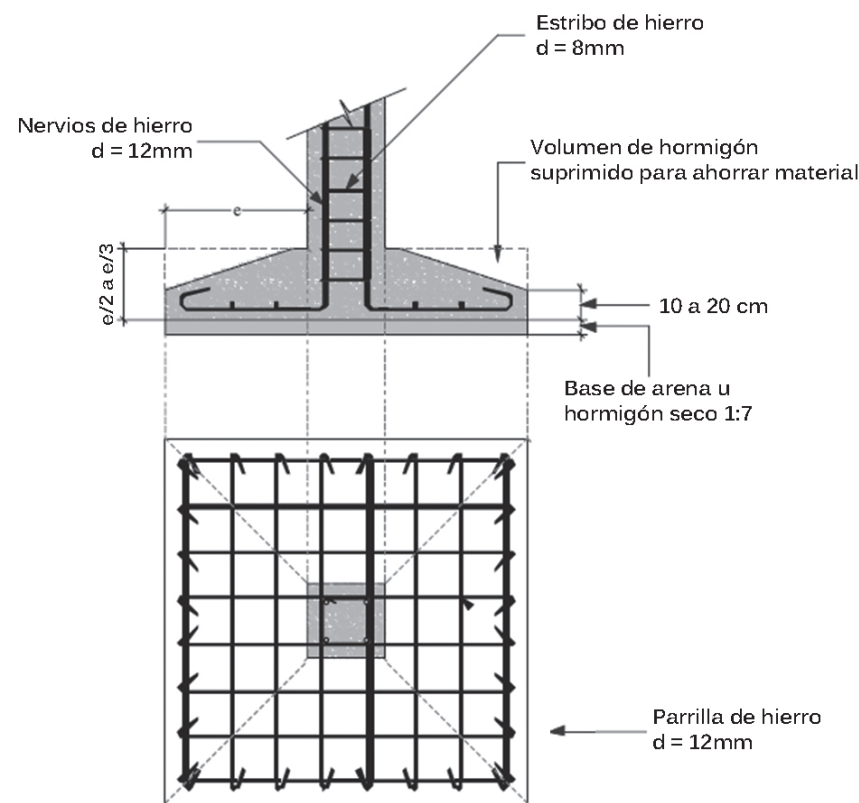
Detalle de una zapata de hormigón armado bajo columna armada
